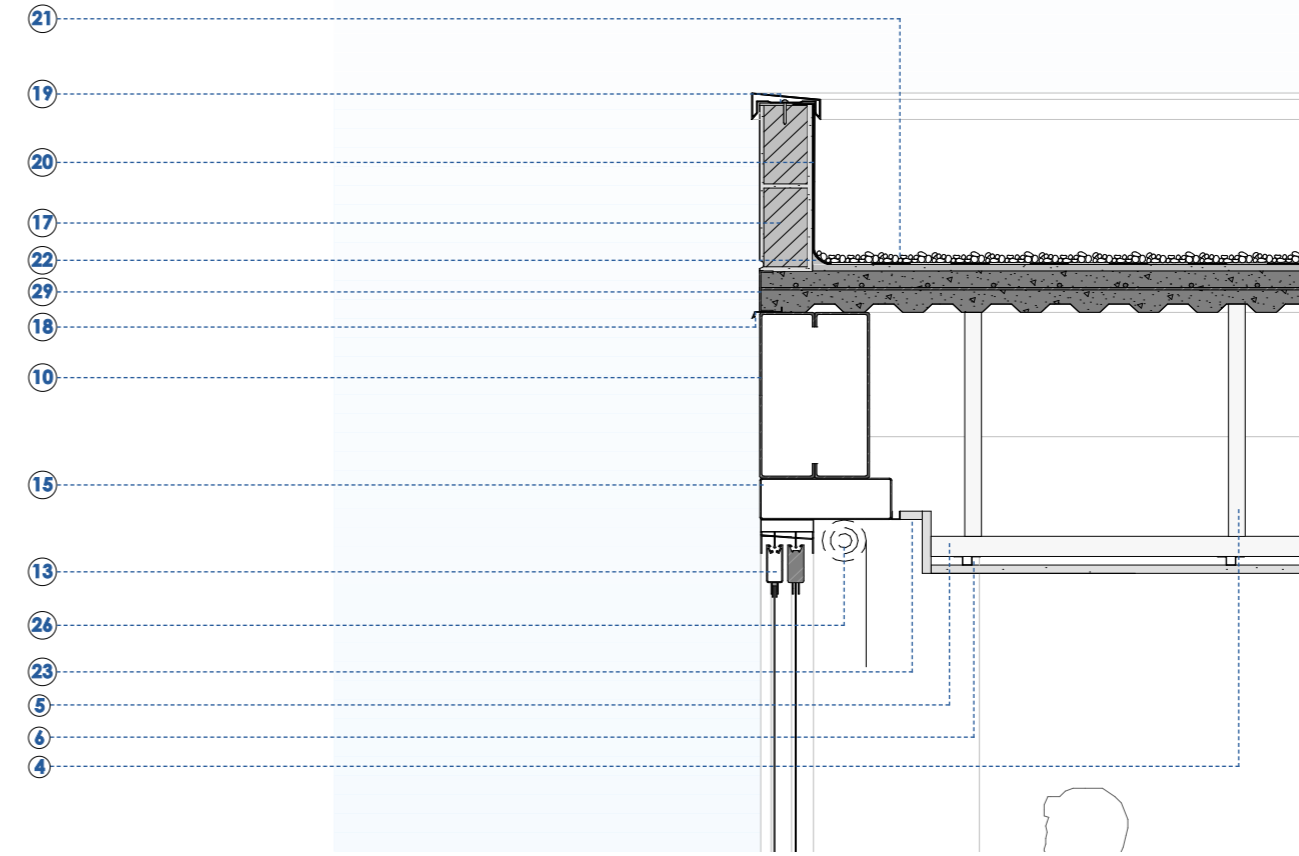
Detalle Constructivo C-4. Fuente: Elaboración propia (2026)
